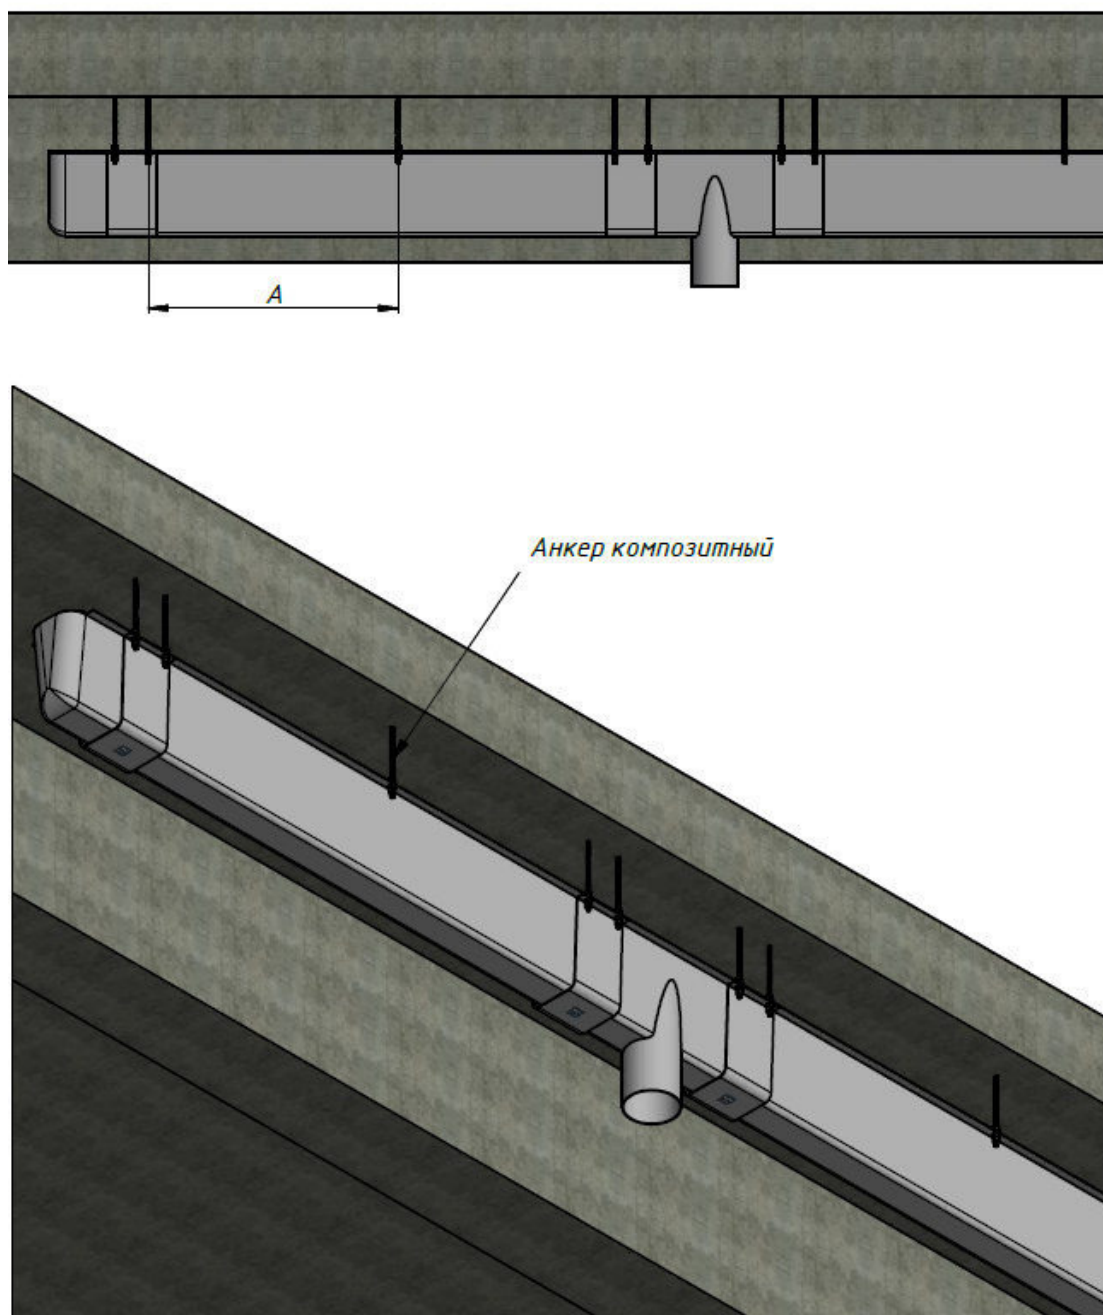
Монтаж водоотводных лотков на бетонные, железобетонные, каменные, армокаменные конструкции
